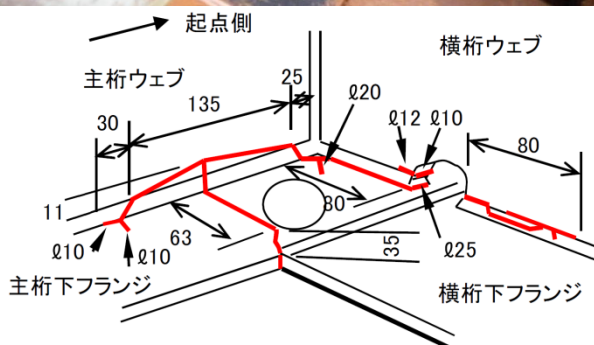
東 P187-1 損傷状況 (2010 年点検時)
